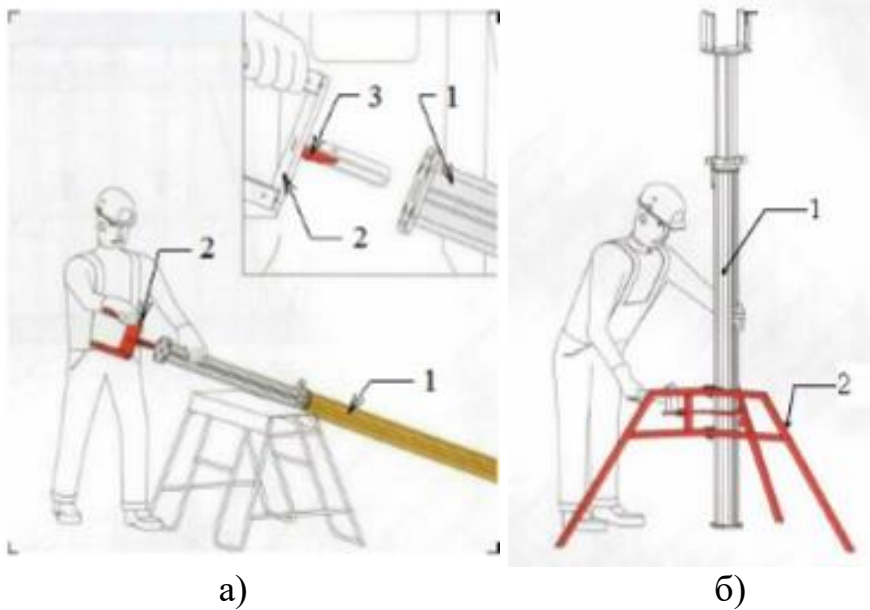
Укрупнительная сборка: а: 1- стойка; 2 – унивилка; 3 – пружинный фиксатор. б: 1 – стойка с унивилкой; 2 – тренога.
